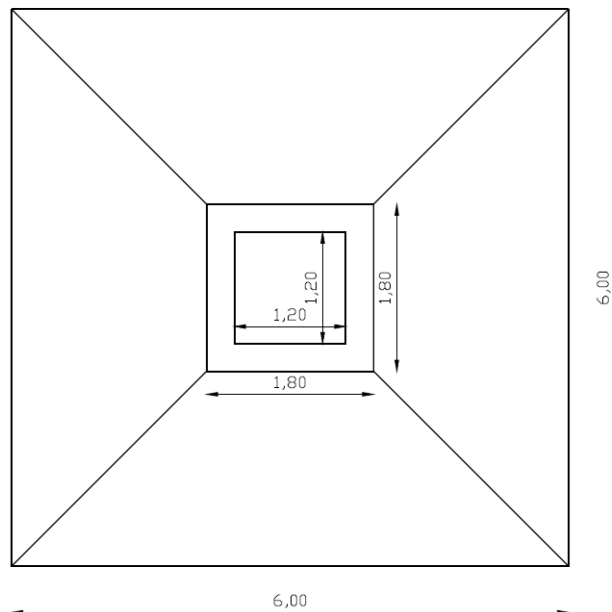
Vista en planta zapata de hormigón armado
